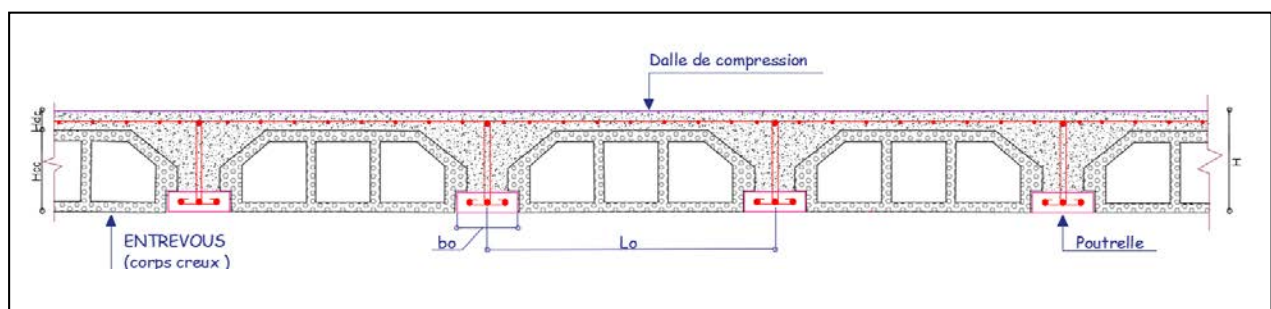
Coupe transversale d'un plancher à entrevous.
